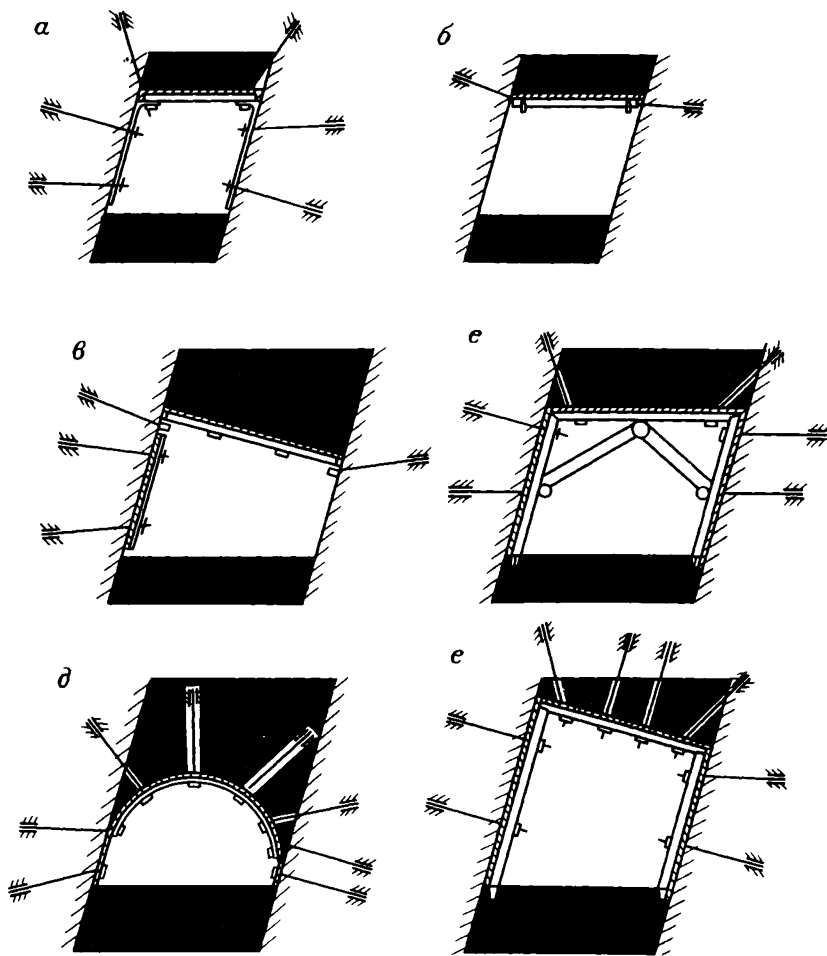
Схемы крепления вентиляционных штреков, проводимых по пластам крутого падения с обнажением боковых пород
